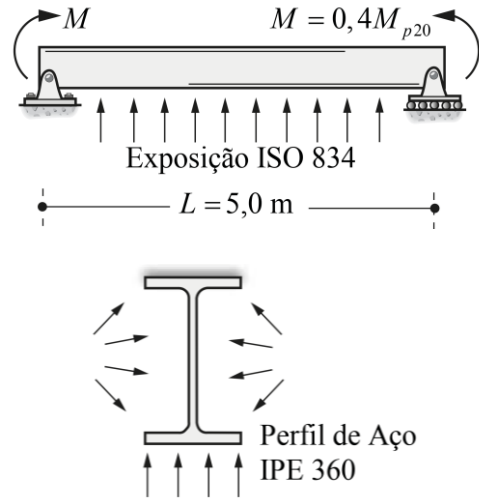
Características do modelo estrutural e da seção transversal da viga de aço
